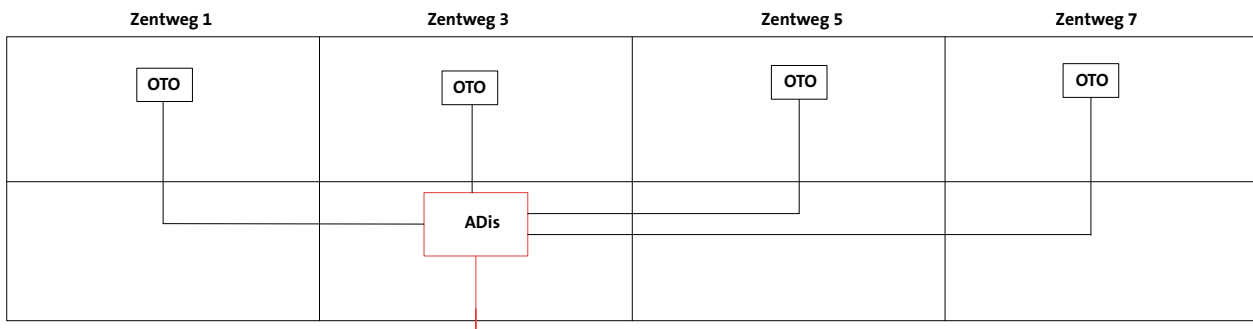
Esempio, più edifici costruiti adiacenti con struttura di collegamento (BSO/US) (l'OTO potrebbe essere cablata all'ADis anche attraverso il FD)
